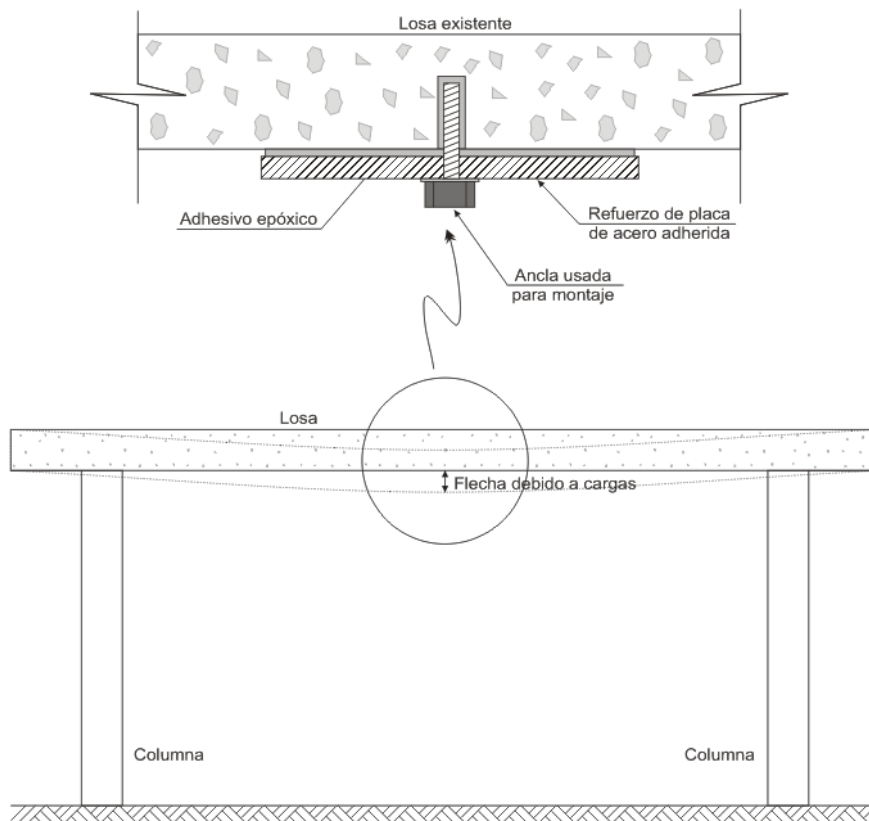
Corrección de una losa flexionada con una placa de acero adherida.
